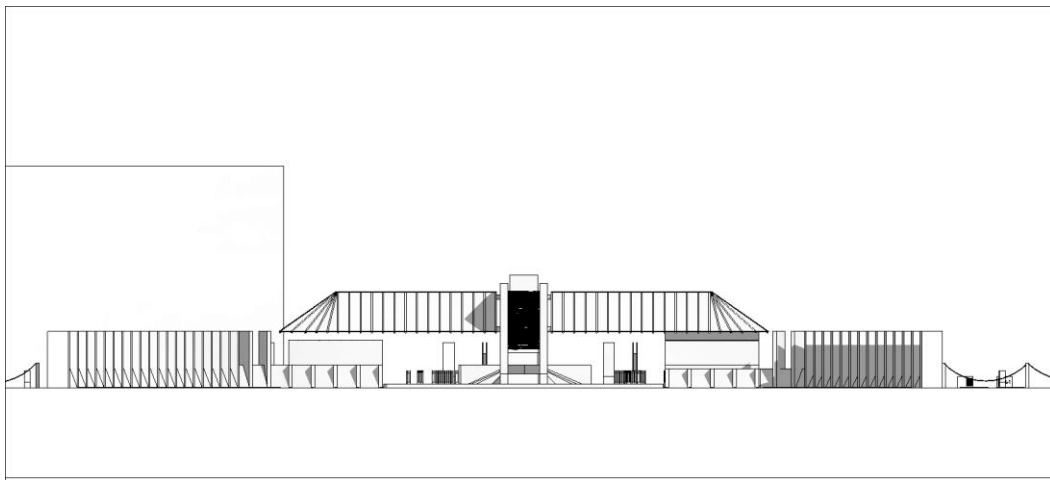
Fachada de acceso (Caseta de acceso y plaza de acceso).
